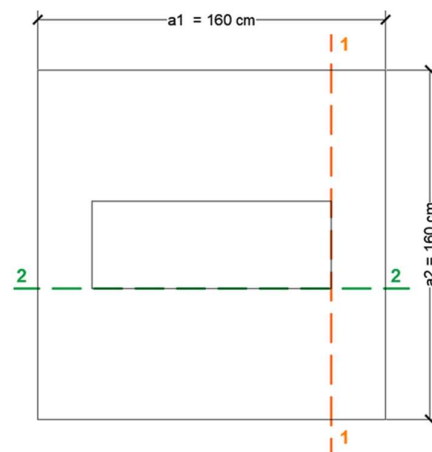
| Secciones críticas de la zapata a flexión. Fuente: Elaboración propia.
